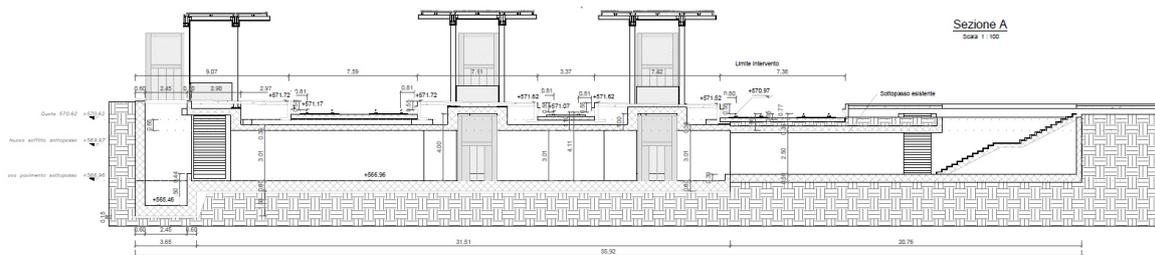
Prolungamento sottopasso di stazione SL01 - Sezione longitudinale
